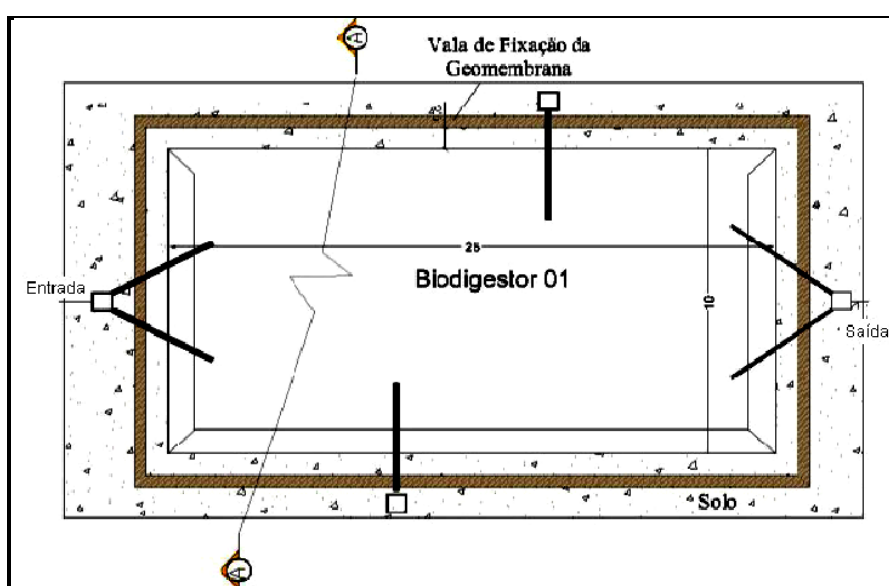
Planta baixa do biodigestor 1 da UGC.
